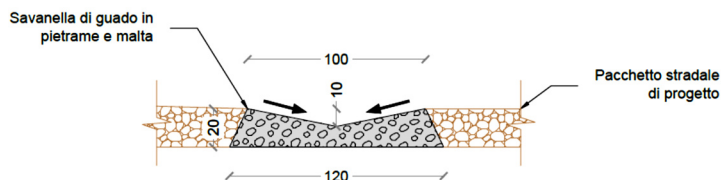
Sezione "Tipo" canaletta di drenaggio realizzata in scavo
